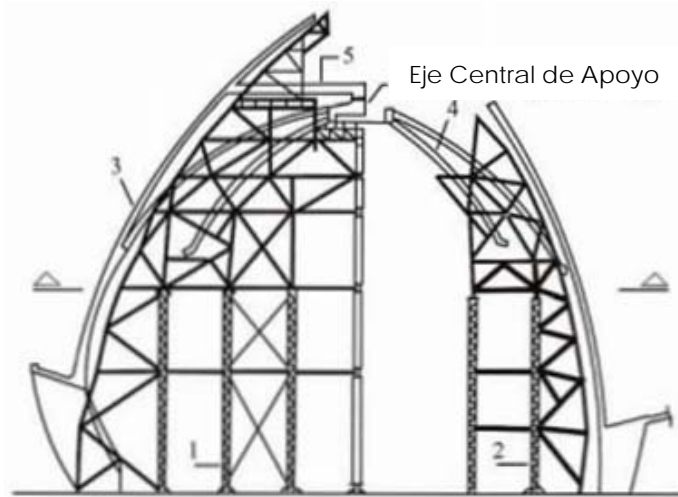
Encofrado de las Hojas Superiores con apoyo en el eje central
